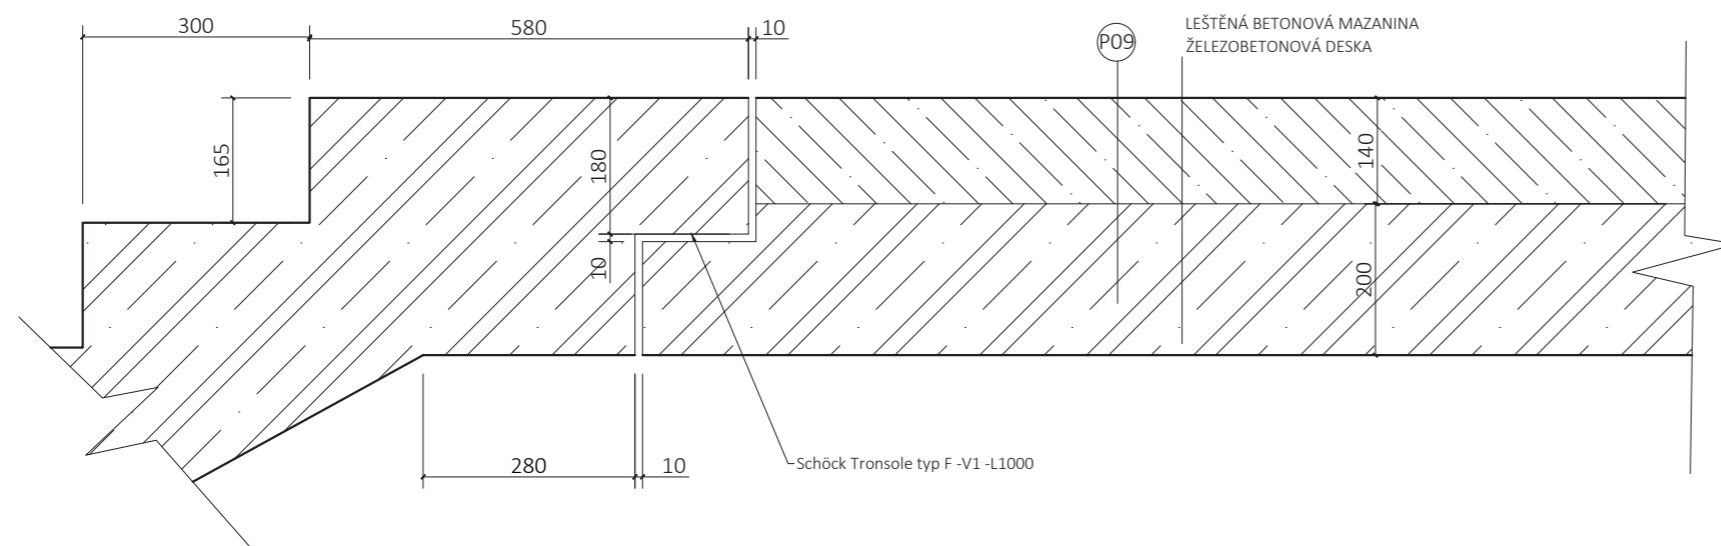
DETAIL NAPOJENÍ ZÁKLADOVÉHO PASU M1:5
